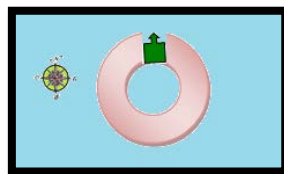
Planta de la torre del Cambrón. Sin escala. Elaboración propia.
